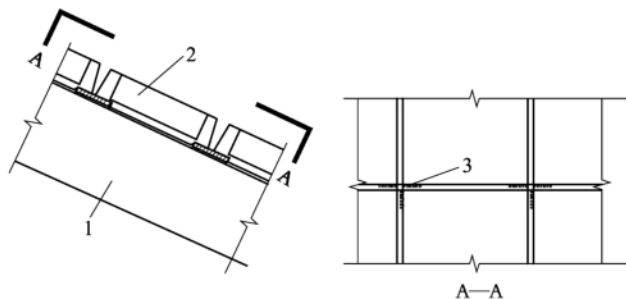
屋面板与三角架的连接构造 (一)
